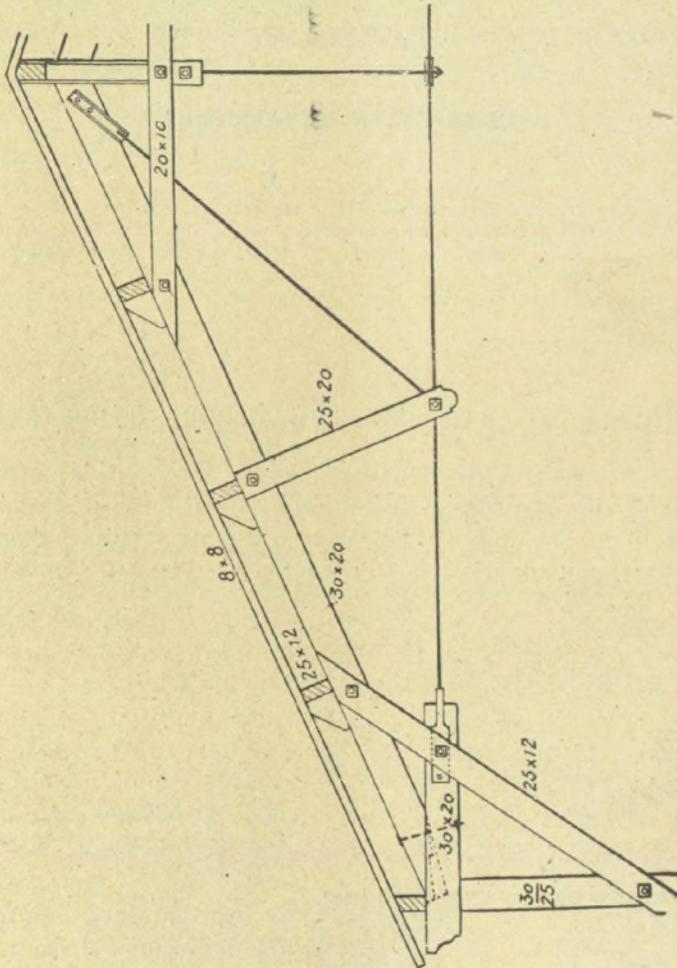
Ferme Polonceau bois et fer avec poinçon et entrait retroussé.
